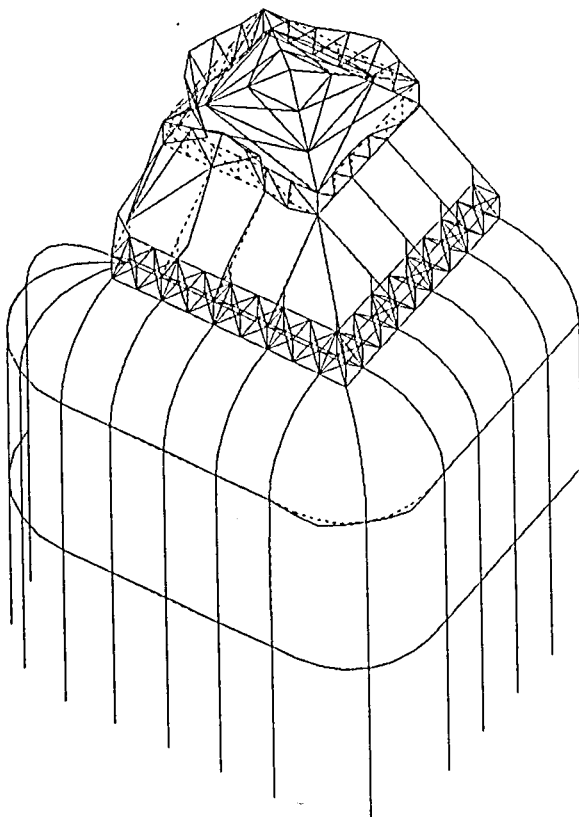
Shopent com sistema de contraventamento. Modo de instabilidade 1.
